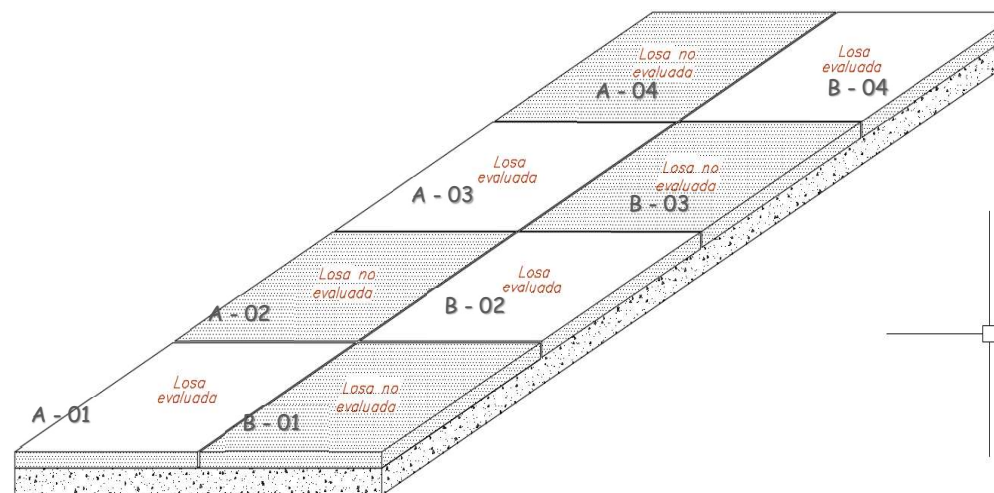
Orden de losas evaluadas para las fallas por desportillado.
